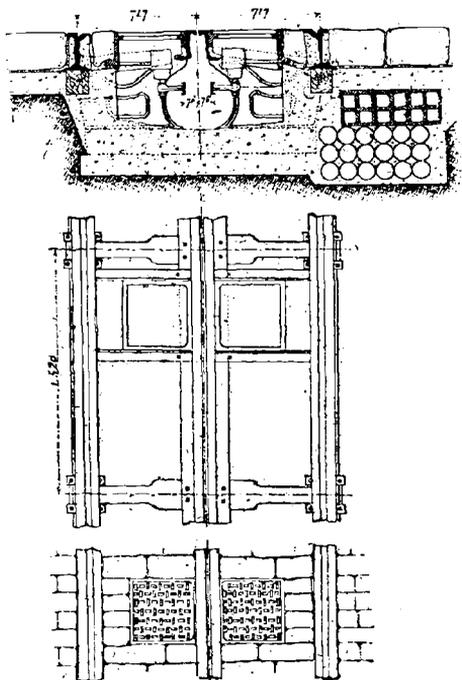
Caniveau de la Third Avenue. — Plan et coupe transversale.
